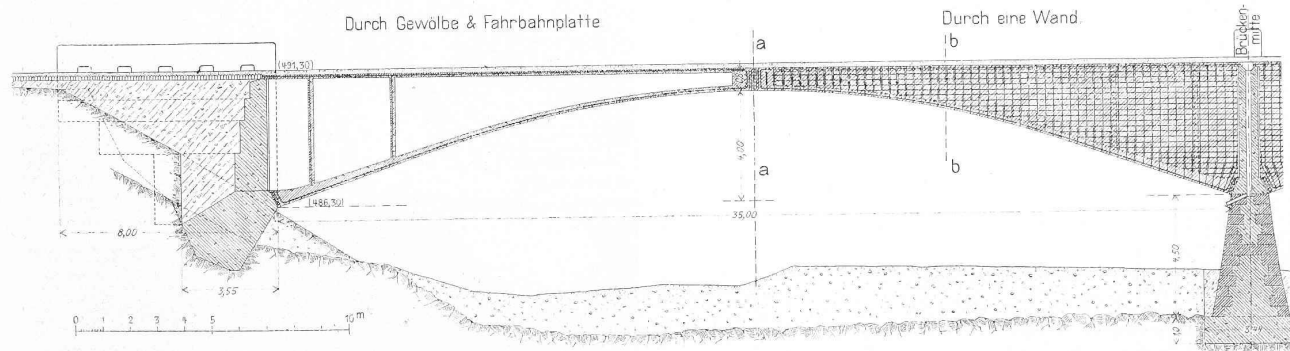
Längenschnitt einer Brückenöffnung mit den Eiseneinlagen. — Masstab 1:250.
